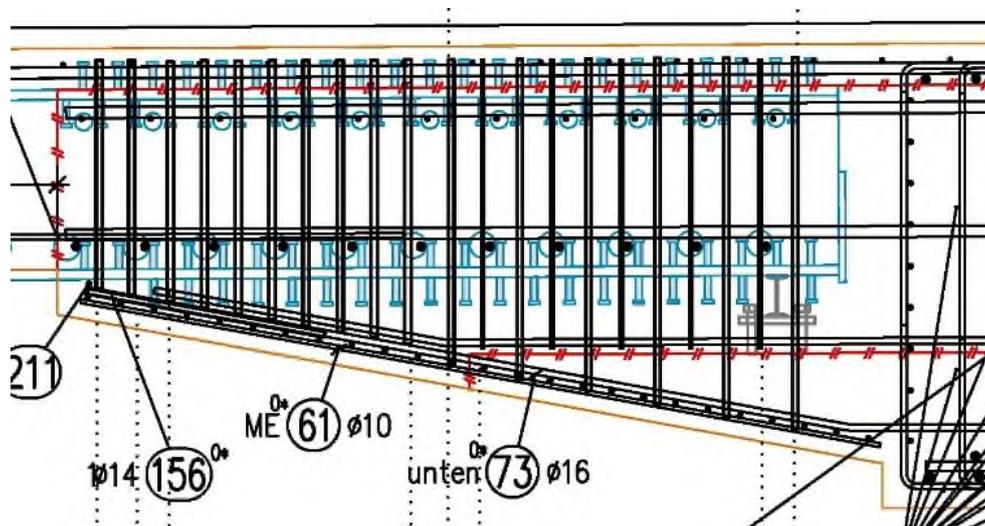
Auszug aus dem Längsschnitt der zu untersuchenden Konstruktion. Quelle: MKP GmbH
